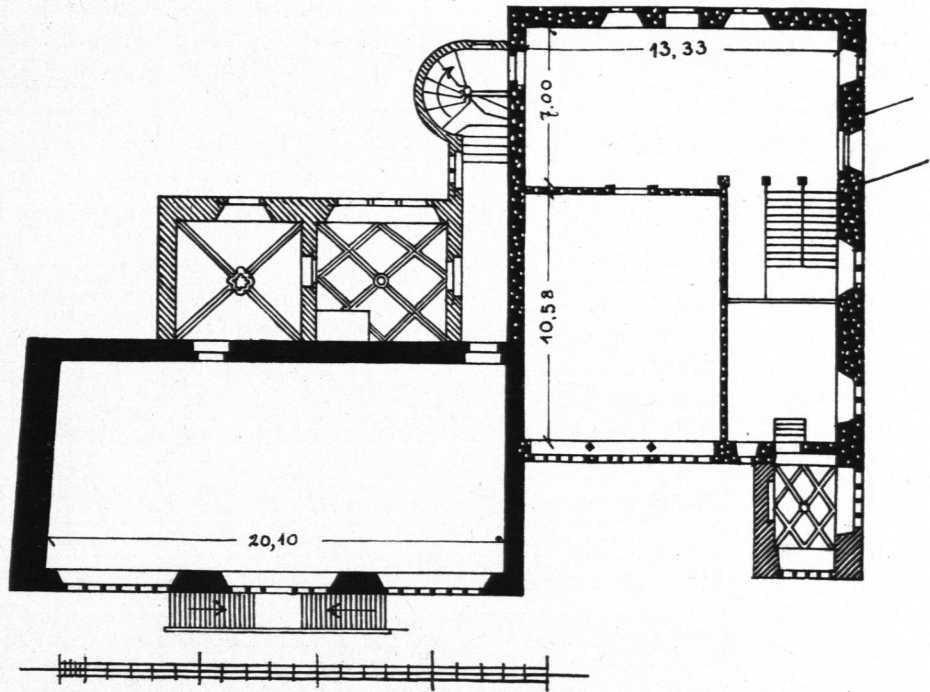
Rathaus zu Ueberlingen. Grundriß.
